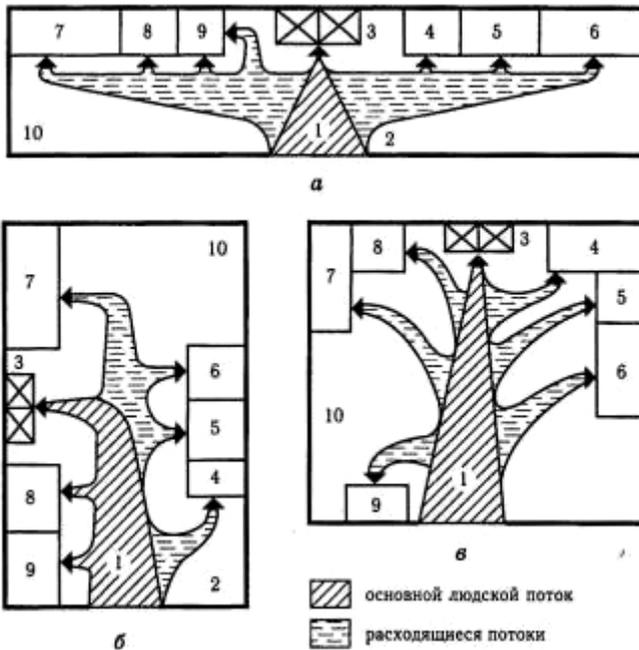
Схемы планировочной организации помещений вестибюльной группы:
